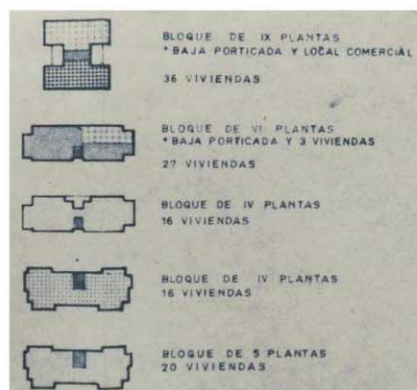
Tipologías de viviendas existentes en el barrio hasta 1984. Plano original
